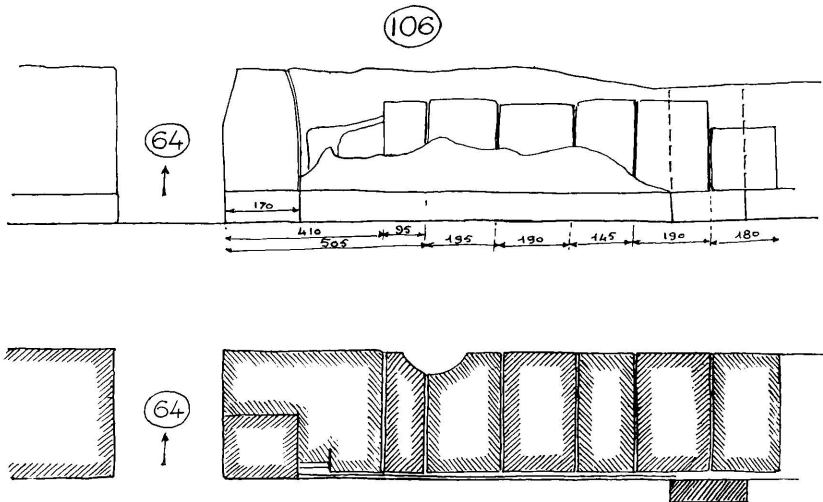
Cour 106. Mur sud. Technique de la construction.
